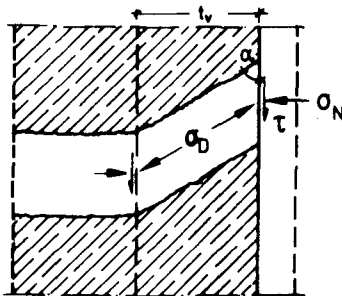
Verbundablösungen und Ausbildung von Verbundrisse innerhalb der Verbundschicht eines Dehnkörpers aus Stahlbeton
